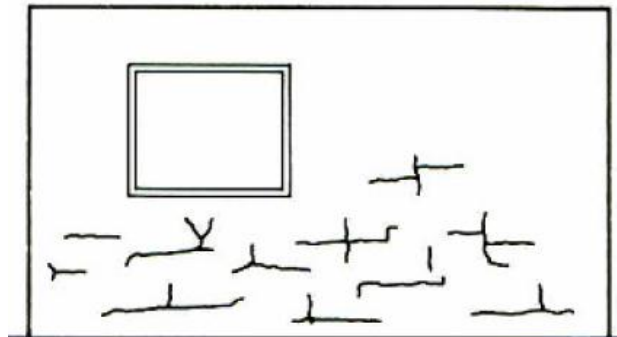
Fissuras na argamassa de revestimento provenientes do ataque por sulfatos.
